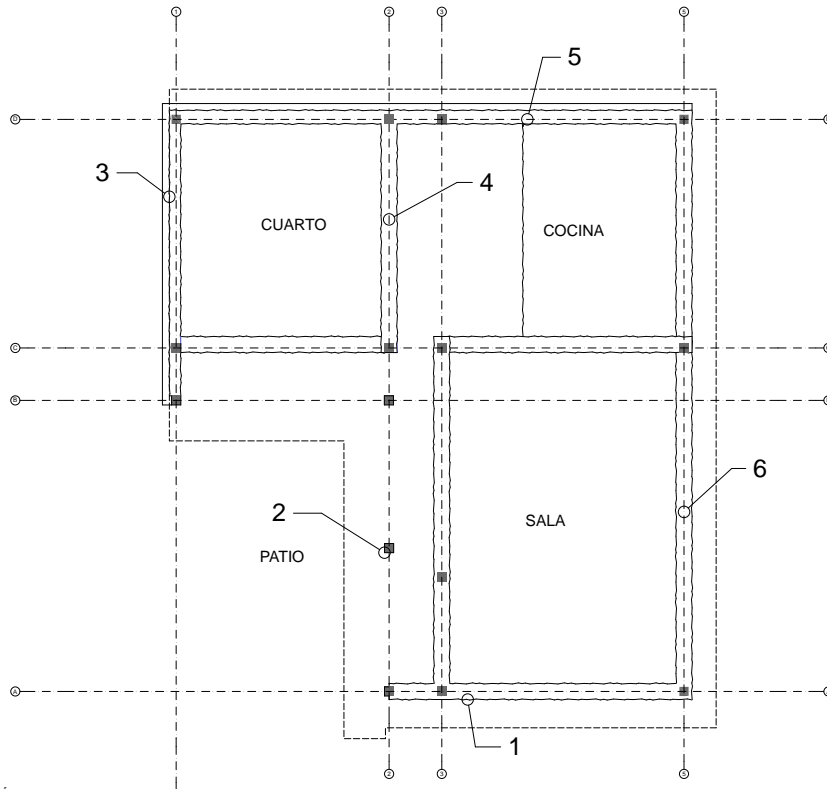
Planta de cimentación. Vivienda Sr. Manuel Guamán.
